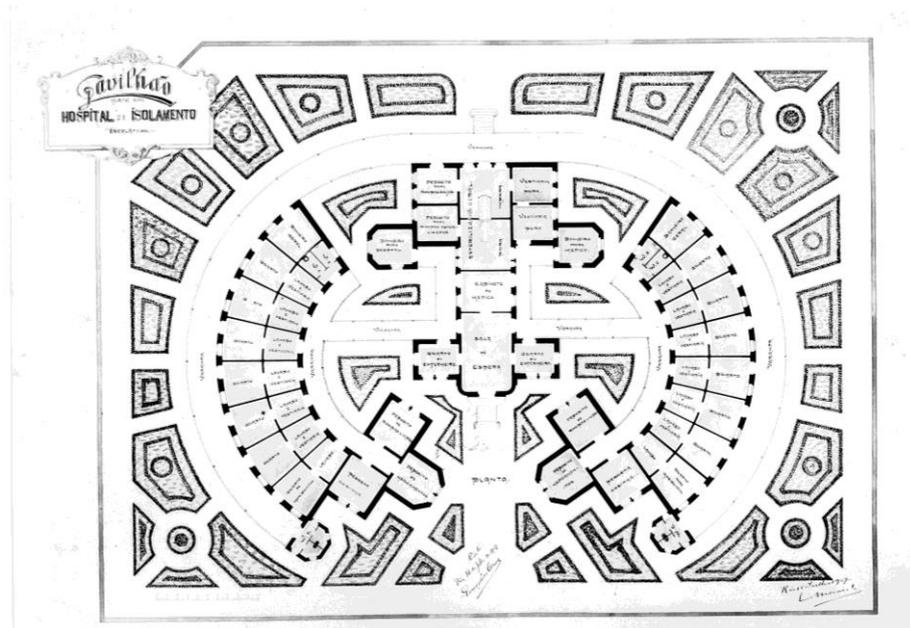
Planta baixa do primeiro projeto do hospital de isolamento – Mangueiras - 1907. (DAD/COC/Fiocruz)
